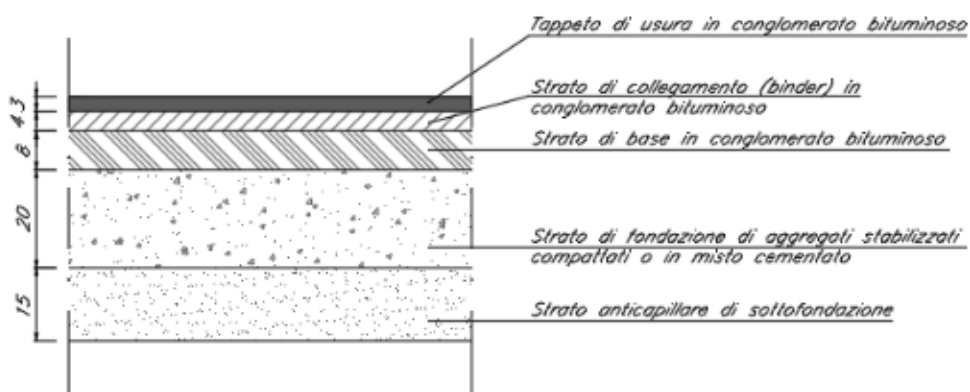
Dettaglio 1, pacchetto pavimentazione corsie
